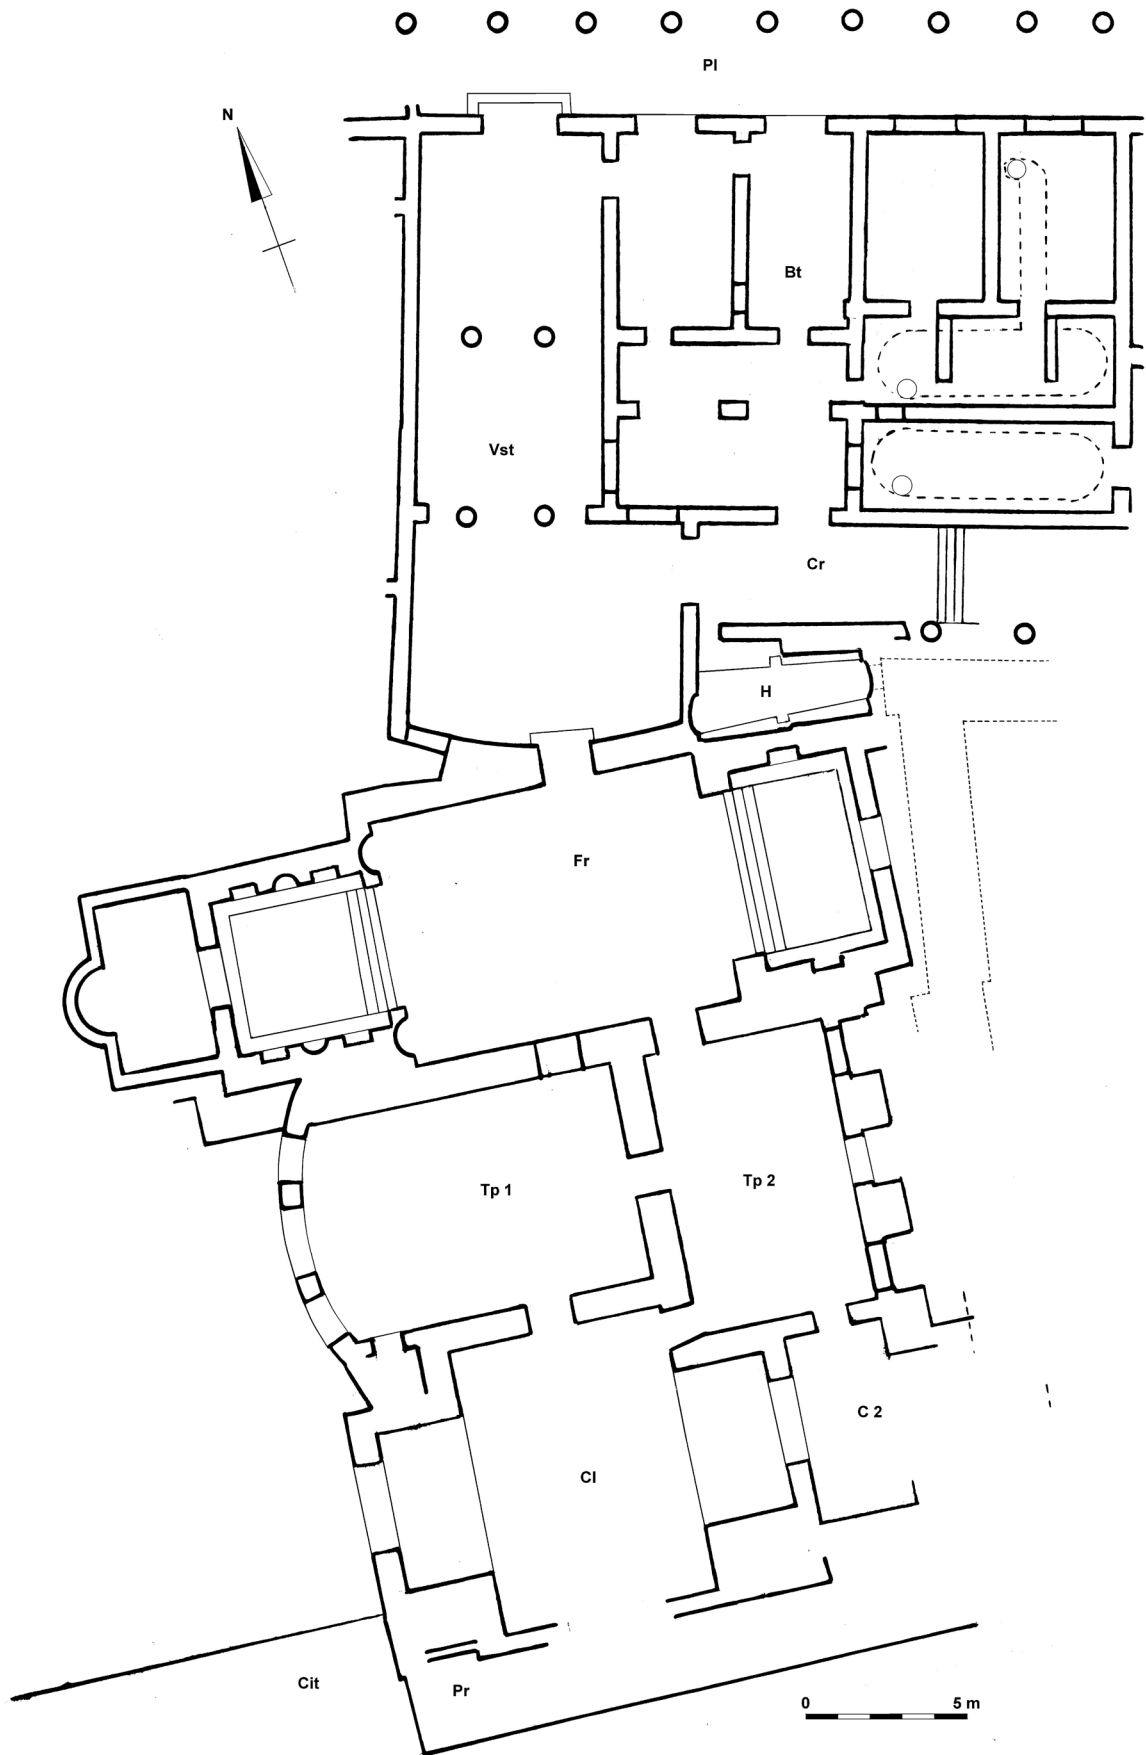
Leptis Magna, plan des Thermes du Levant (M. Paulin).
